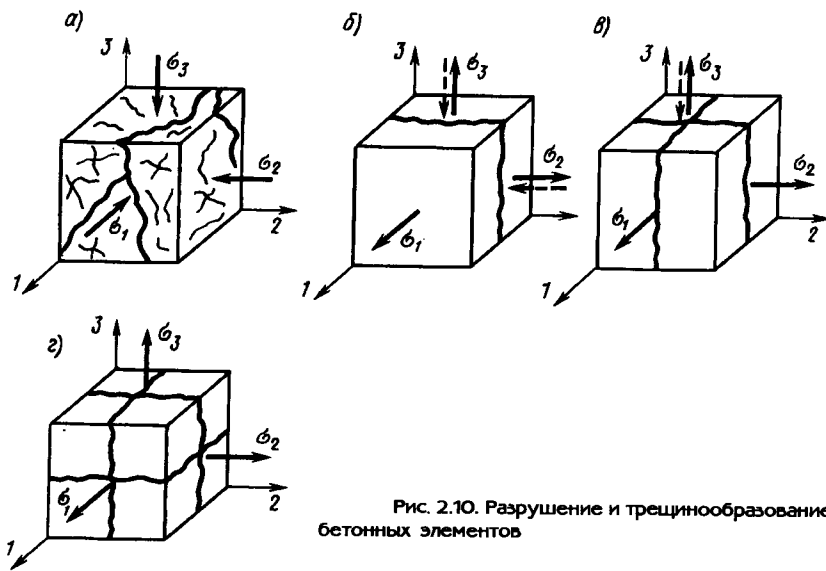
Разрушение и трещинообразование бетонных элементов
